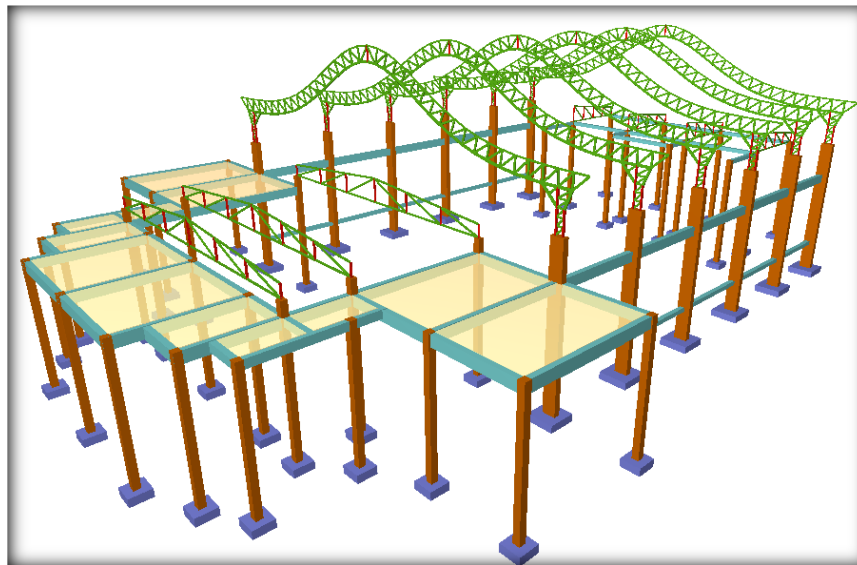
Estructura con Cercha Tipo II, Elaboración Propia
